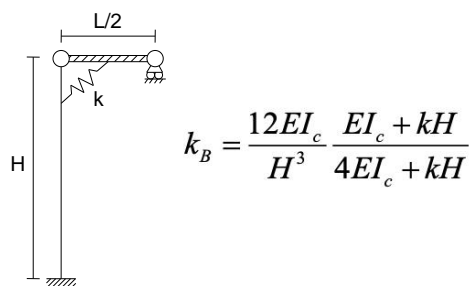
Calcolo della rigidezza k_B nel caso di pilastro laterale.
